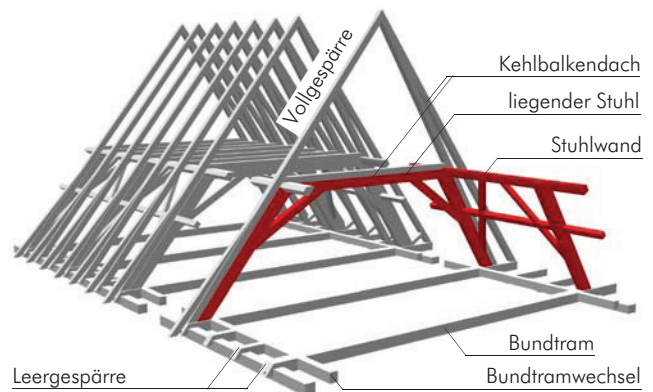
A.19 Räumliche Darstellung eines Kehlbalkendachs mit liegendem Stuhl.
